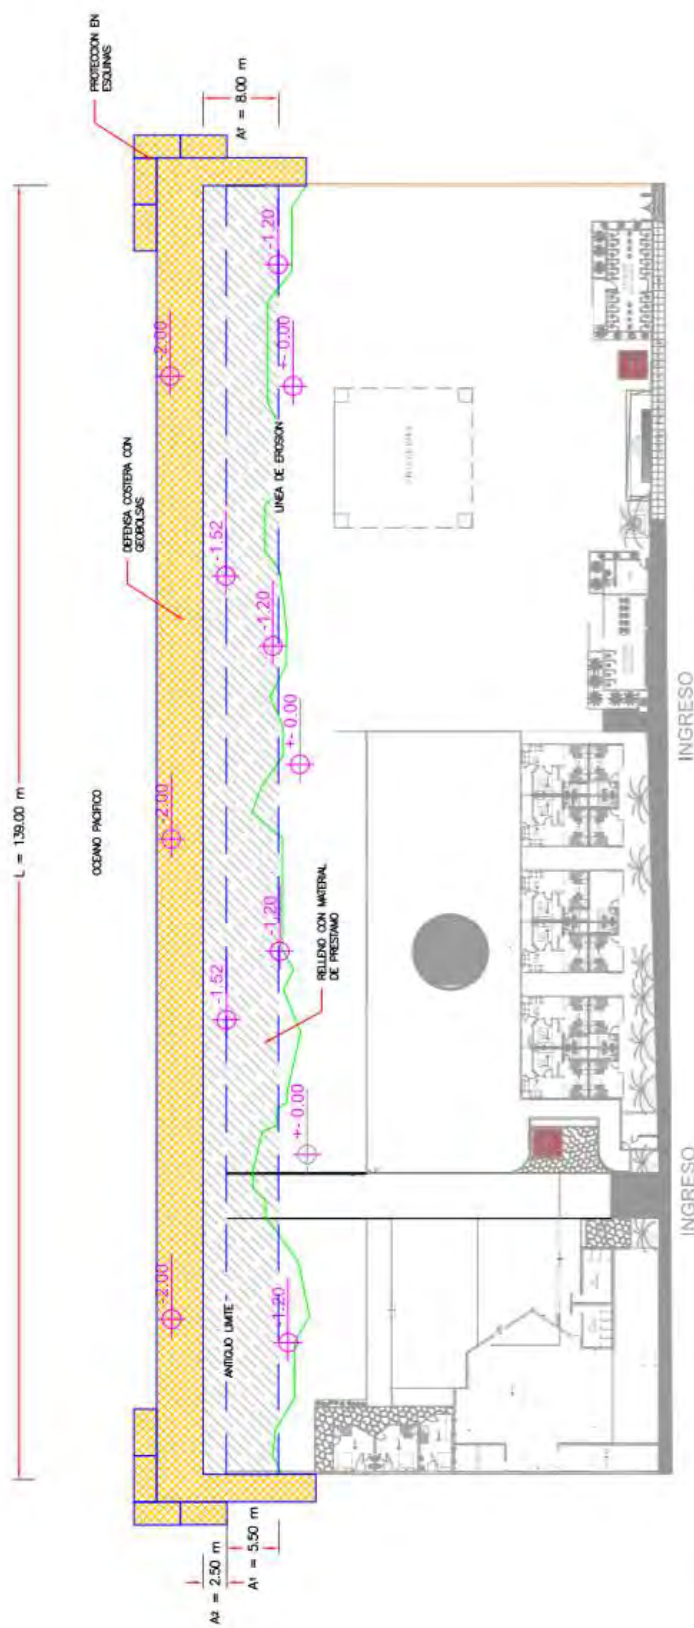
8. Vista en planta de la defensa costera con geotextiles
